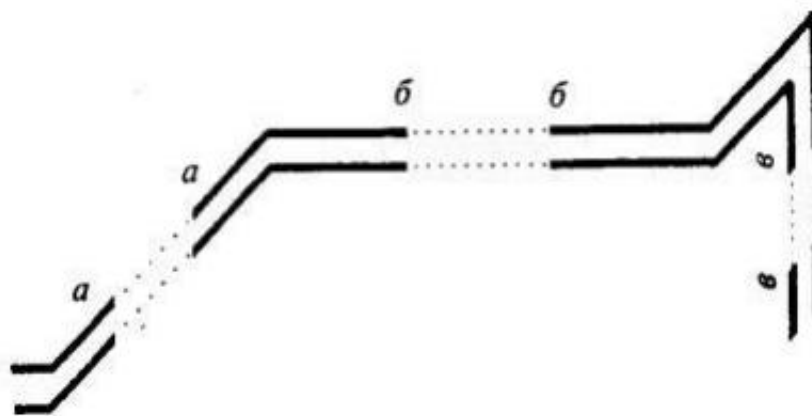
Обозначение разрывов трубопроводов (воздуховодов) на схемах систем.
